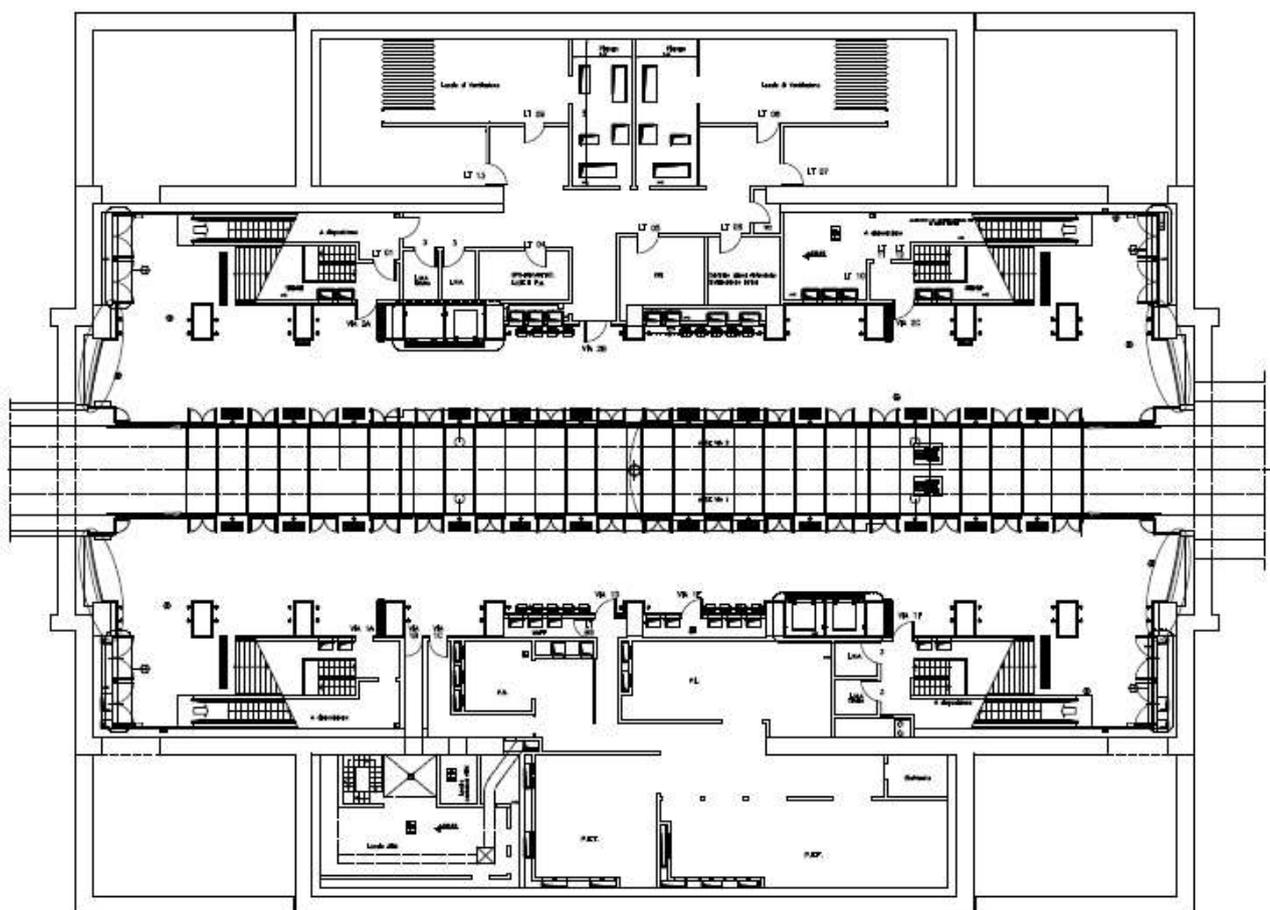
Pianta aerea banchina stazione metropolitana Porta Nuova
